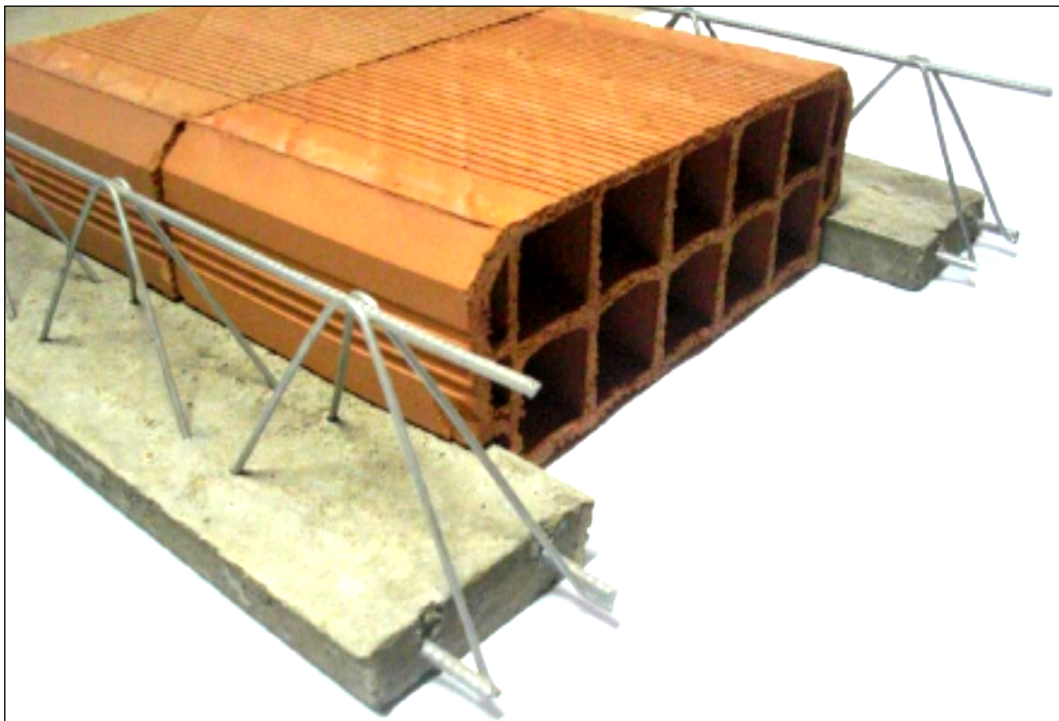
Detalle del Sistema Prefabricado Alitec.
